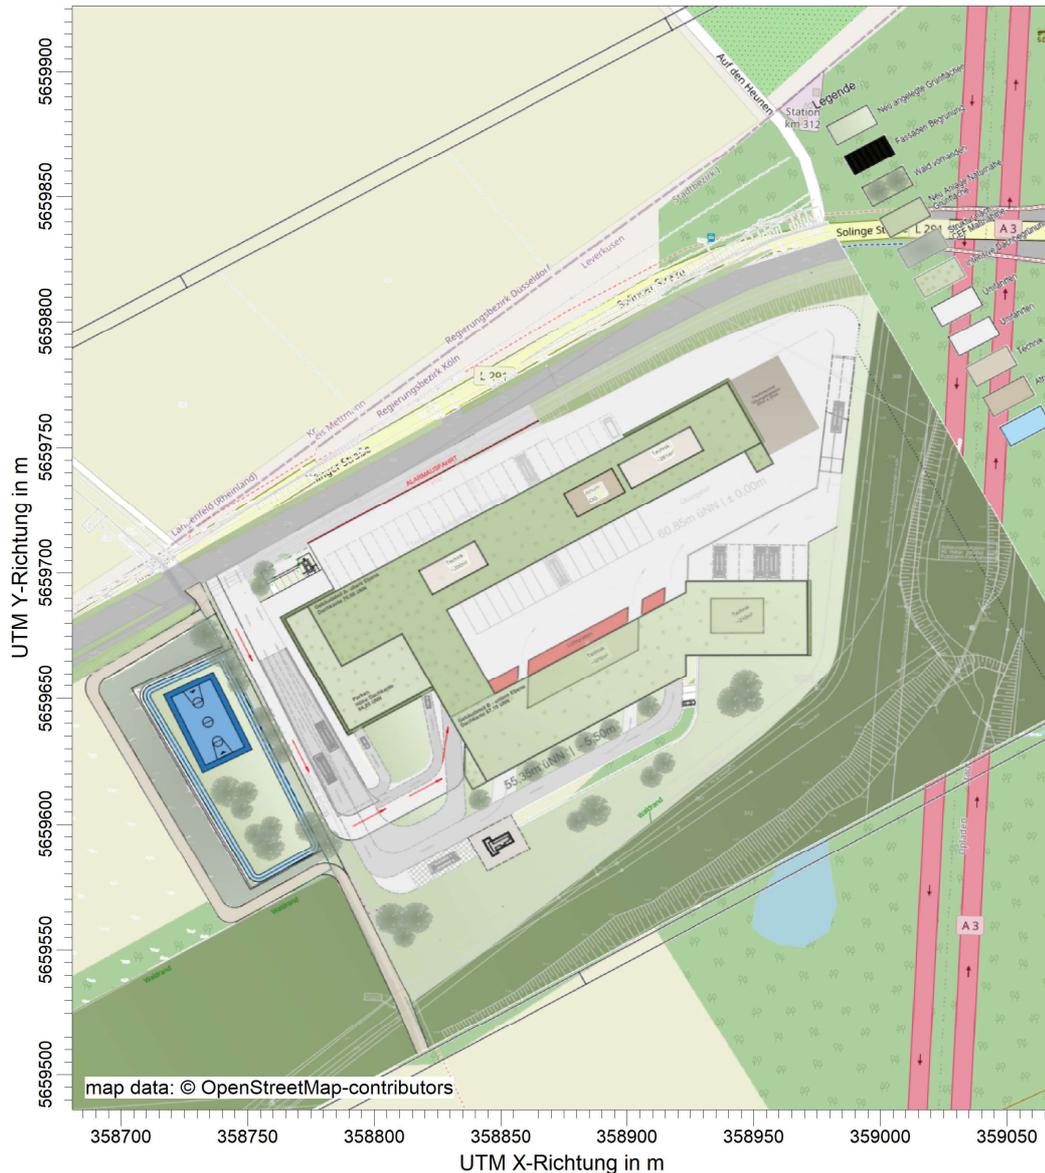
Lageplan mit vorgesehenen Rettungs- und Feuerwache in Leverkusen.
